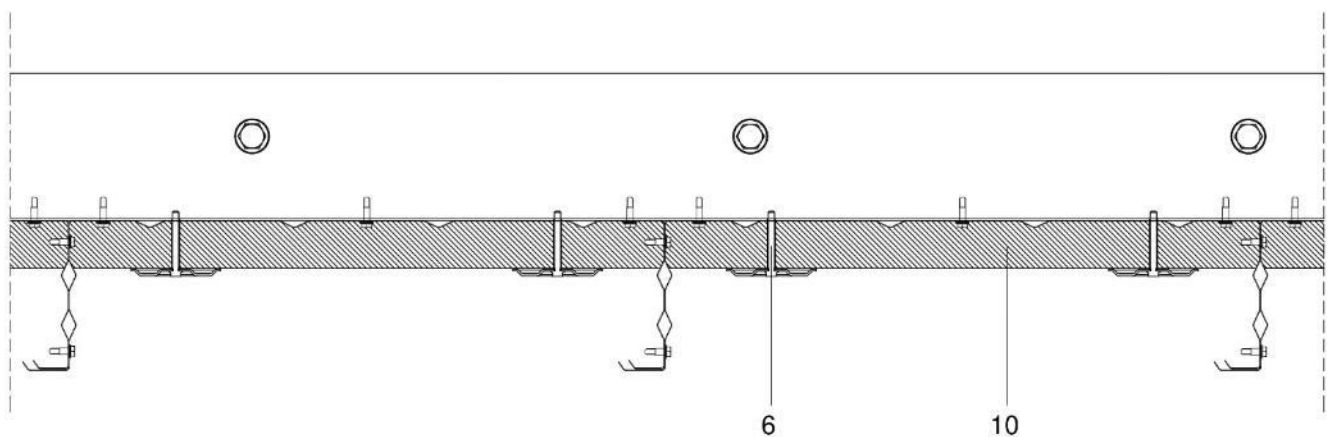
b: Sección horizontal con aislamiento térmico y fijación del aislamiento tipo 1.
